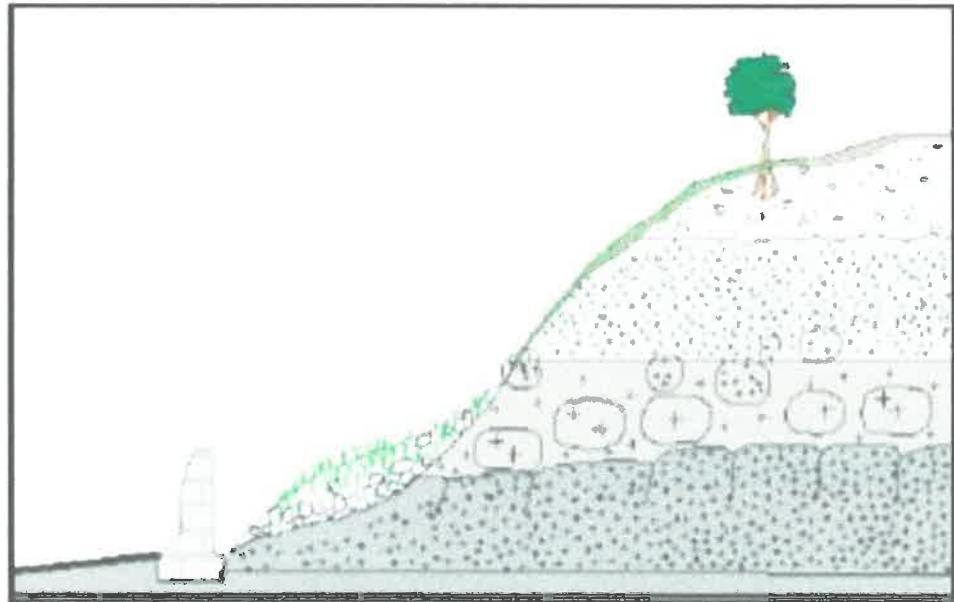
Esquema de un relleno estabilizador sostenido por muro fuente: INGEMMET, 2020.
